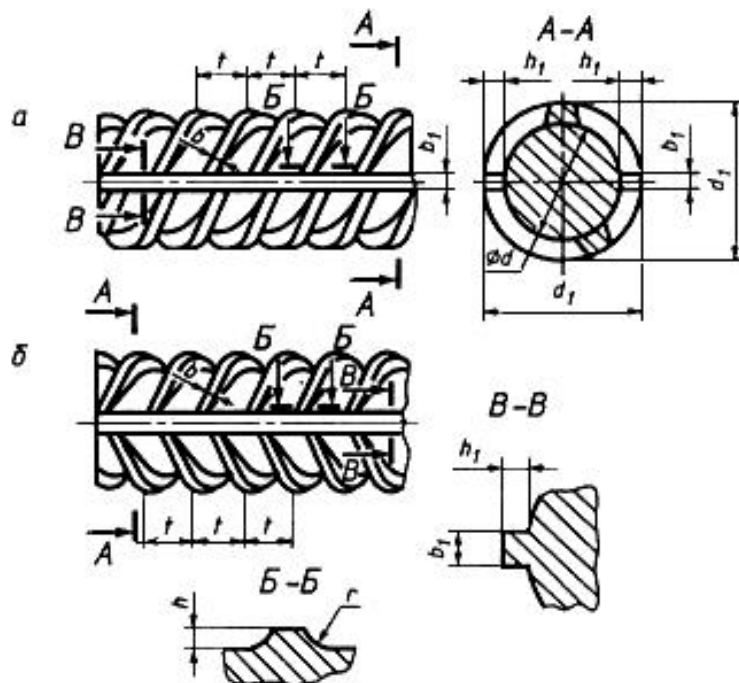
Общий вид строительной арматуры, подвергающейся испытаниям
